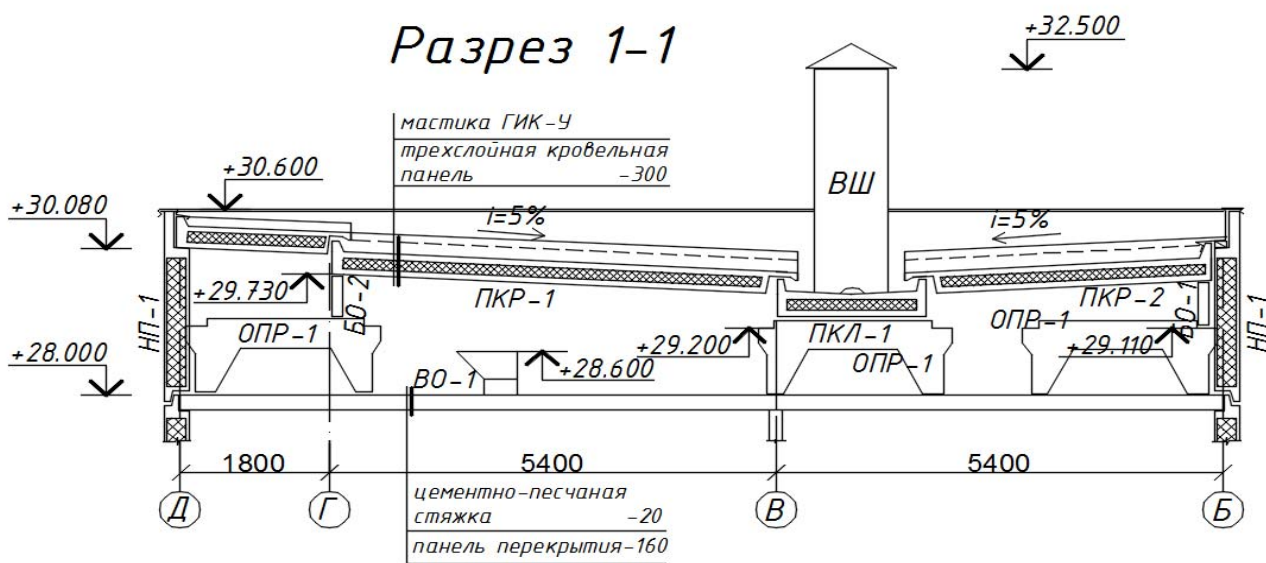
Теплый чердак и безрулонная кровля (поперечный разрез):
